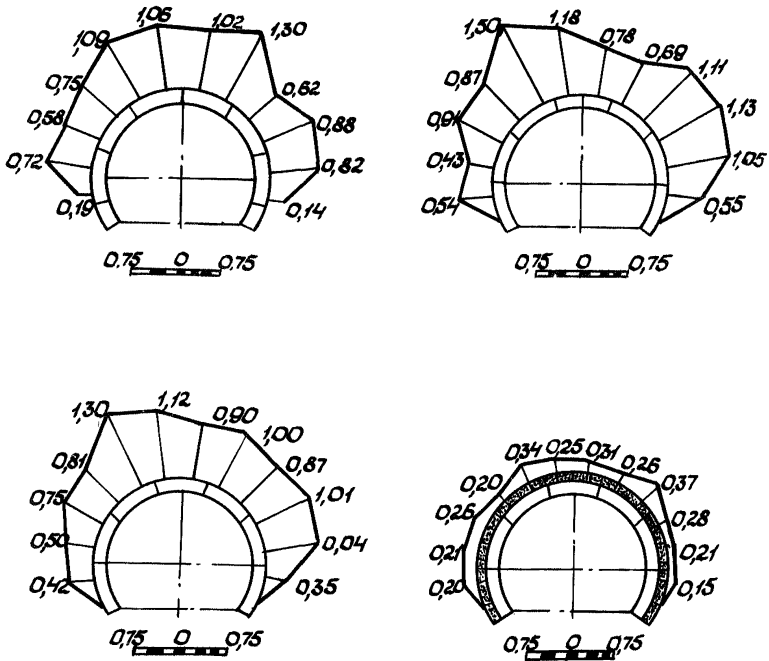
Эпюры распределения нагрузок на сборную железобетонную тьюинговую крепь с податливой забутовкой и без нее.
